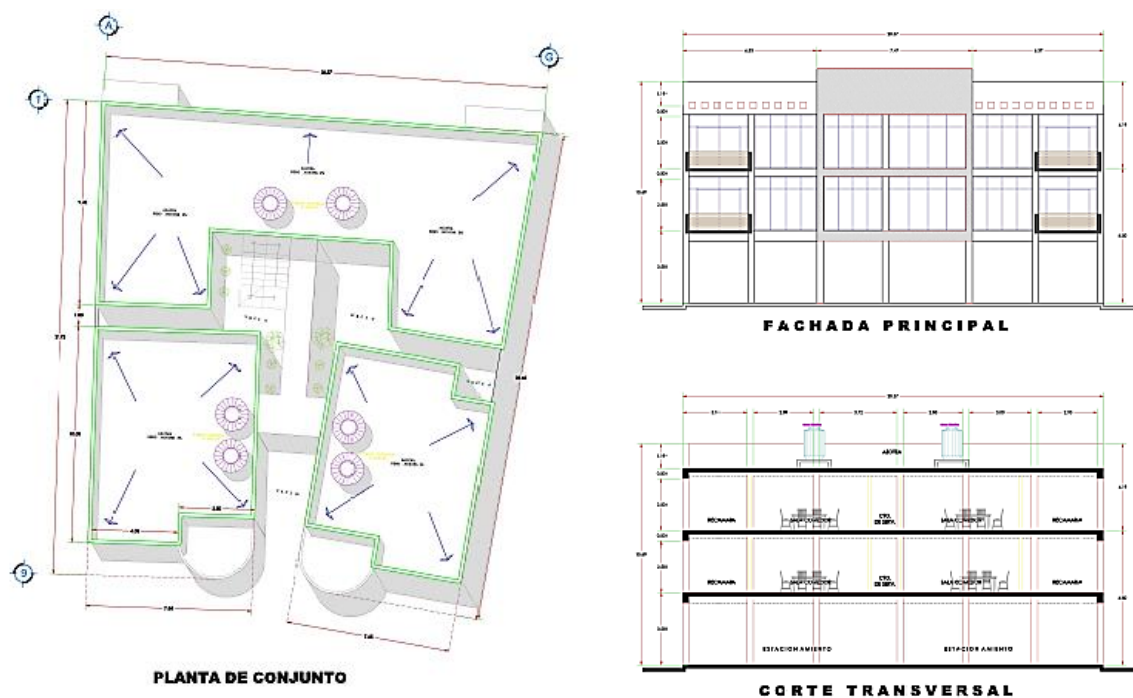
Planta de conjunto, fachada y corte trasversal del proyecto
